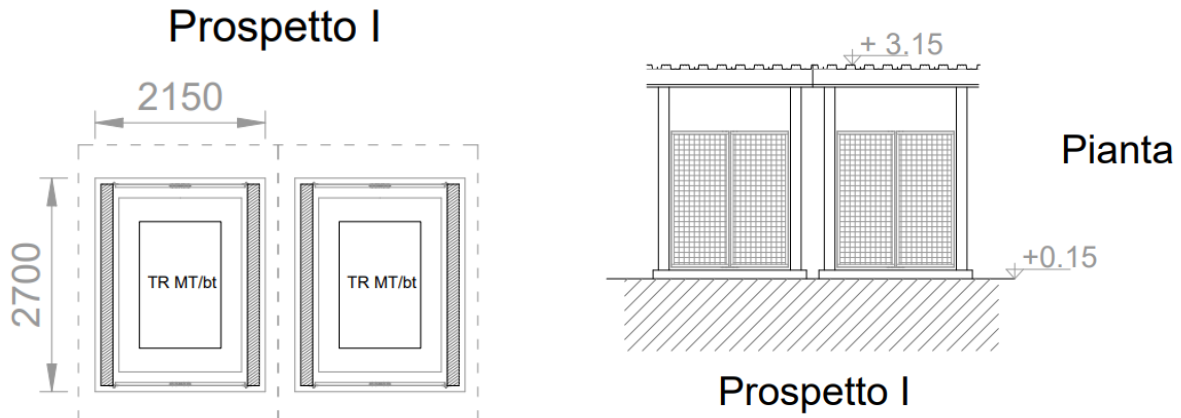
Copertura TR: pianta e prospetti (stralcio Tav.040.25.O1.W.17)
